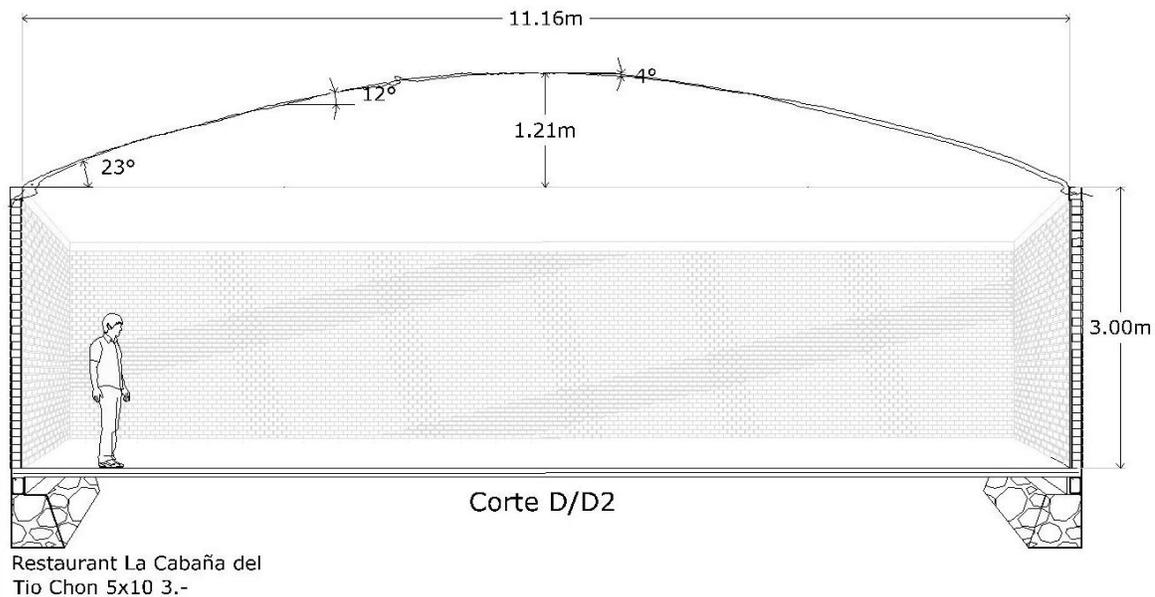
Corte D/D2 de Bóveda rectangular 3 del restaurante Tío Chon, con dimensiones de 5.00X10.00m
